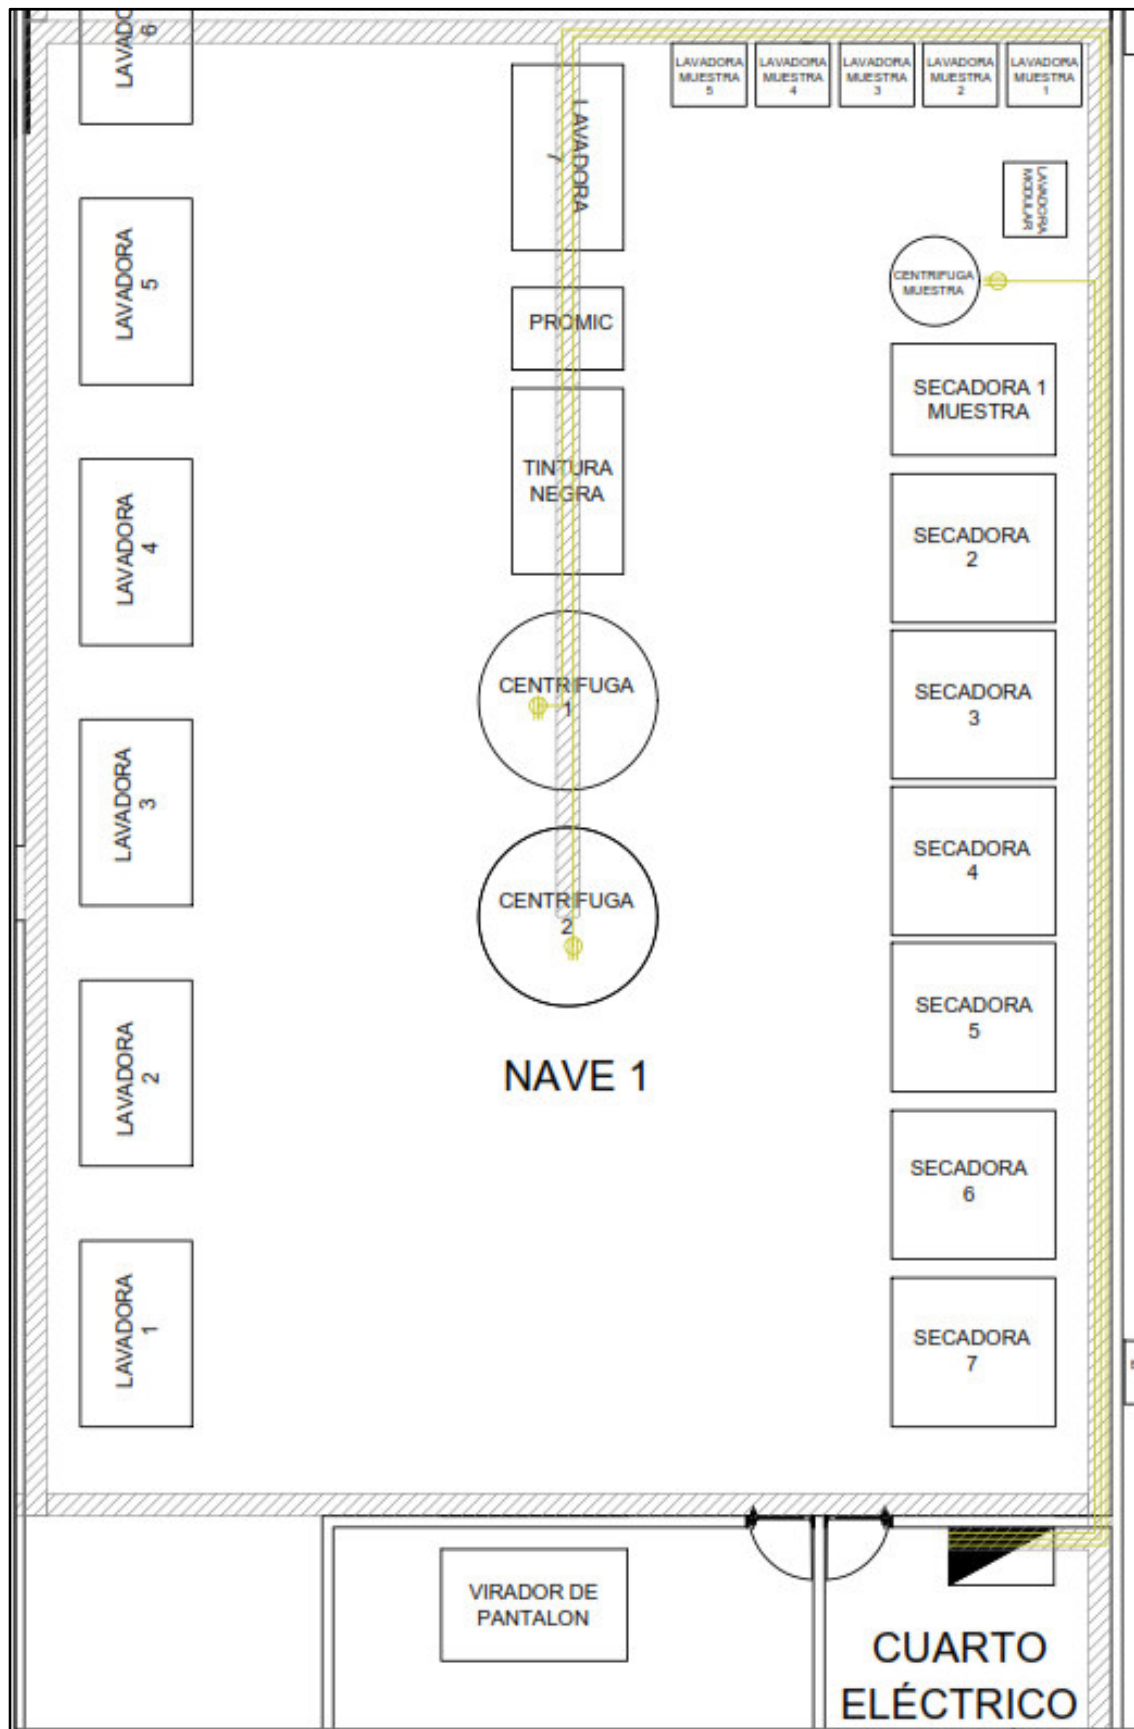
Imagen del plano de bajo voltaje (cable #4)
